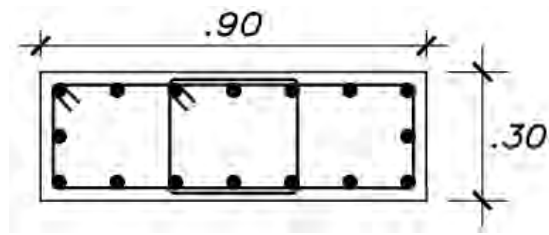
Sección transversal Columna C-10 (Piso 1 a 3).
